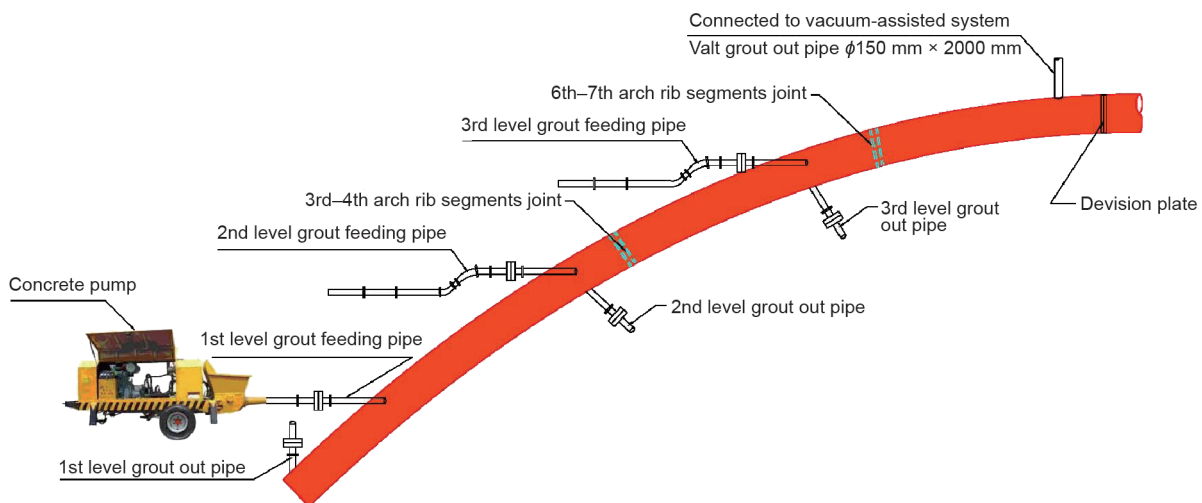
真空辅助三级接力灌注管内混凝土布置方案。
